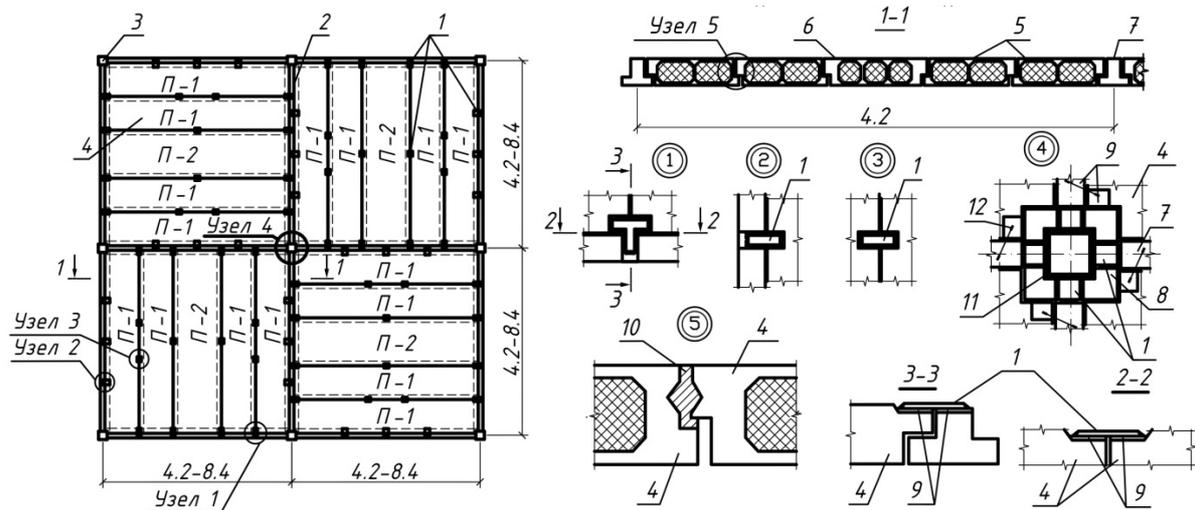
Компонка диска перекрытия системы «ИКАР»: 1 – листовая накладка; 2 – листовая накладка; 3 – колонна; 4 – плита; 5 – крайняя плита; 6 – средняя плита; 7 – ригель; 8 – консоль колонны; 9 – закладные детали; 10 – бетонная шпонка; 11 – узловой элемент; 12 – коротыш
